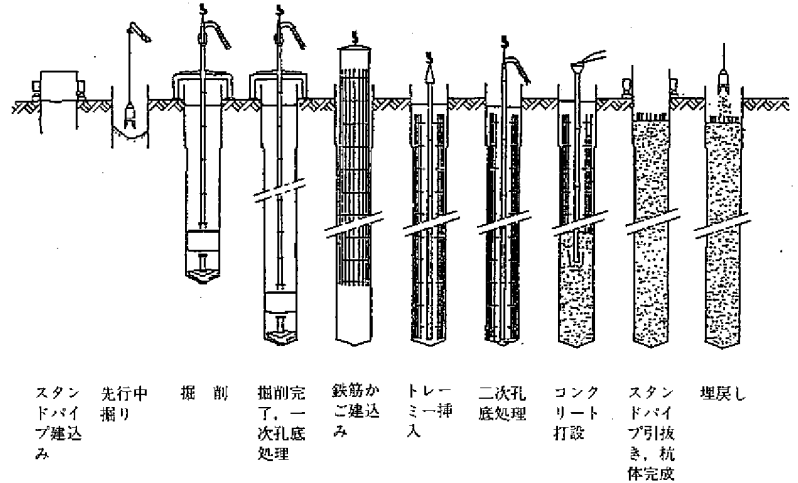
リバース杭施工概念図（杭基礎施工便覧より）
